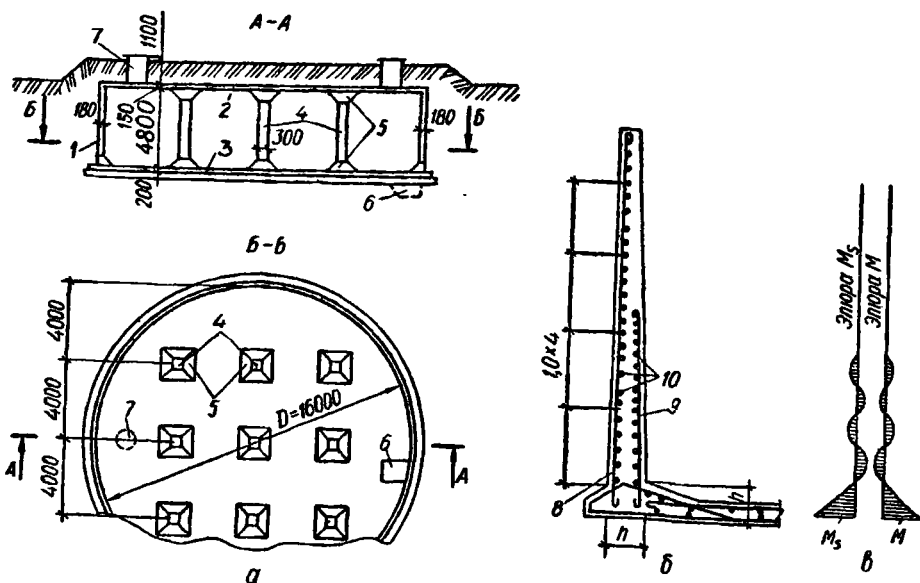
Циліндричний залізобетонний монолітний резервуар з безбалковим перекриттям: а — конструкція резервуара; б — армування стінки; в — епюри згинальних моментів у стінці від тиску ґрунту та рідини; 1 — стінка; 2 — безбалкова плита перекриття; 3 — плита днища; 4 — колони; 5 — капітелі; 6 — приямок; 7 — люк; 8 — вертикальна арматура за розрахунком на момент від тиску ґрунту; 9 — те саме, на момент від тиску рідини; 10 — кільцева арматура за розрахунком на розтягувальне зусилля
